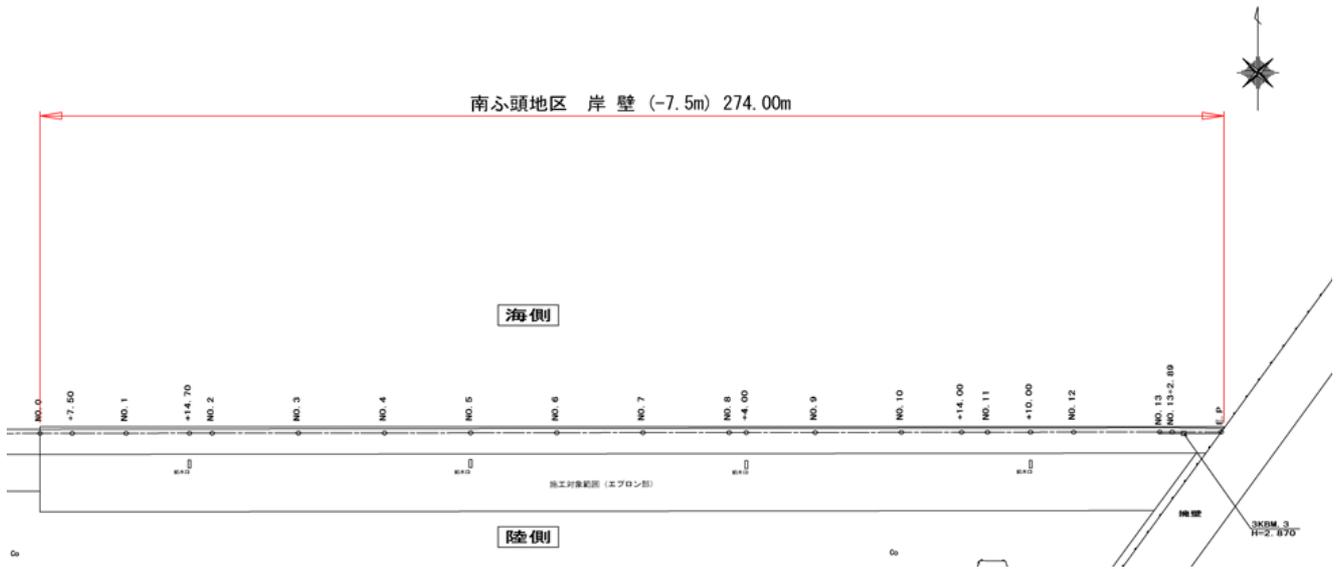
250 No.23 常陸那珂港区_南ふ頭地区 C岸壁 (-7.5m) の平面図 (被災前)
